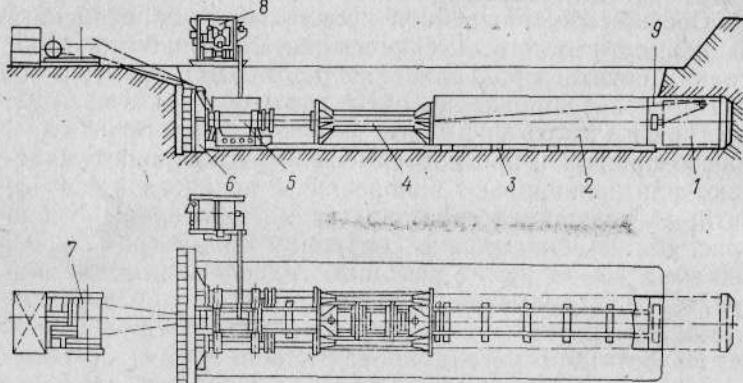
Схема установки У-12/60 для бесструбнейной прокладки труб
